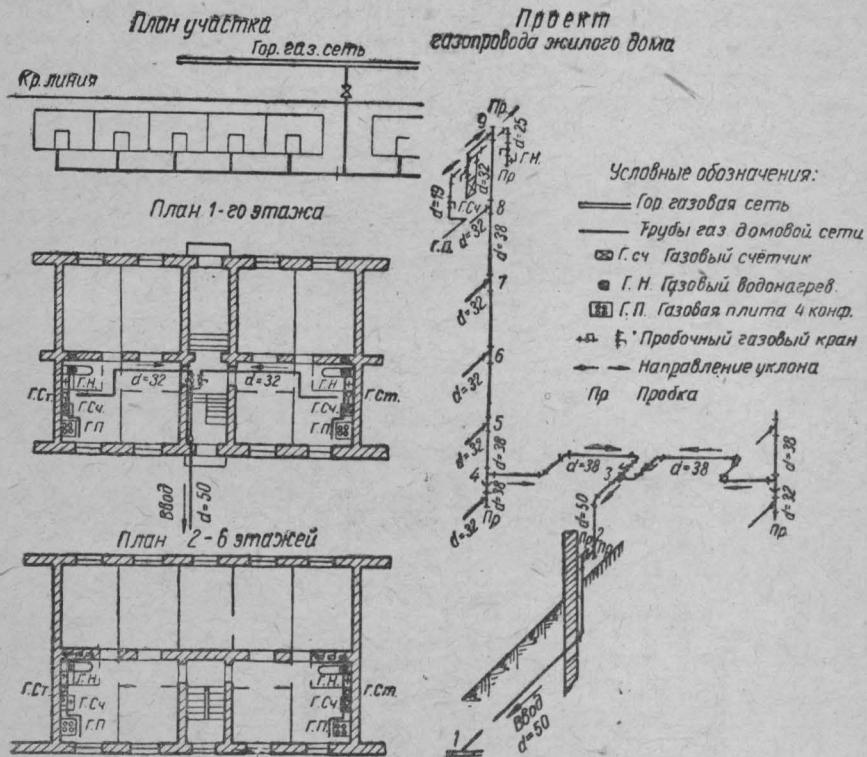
Проект газопровода жилого дома и схема газопровода.
